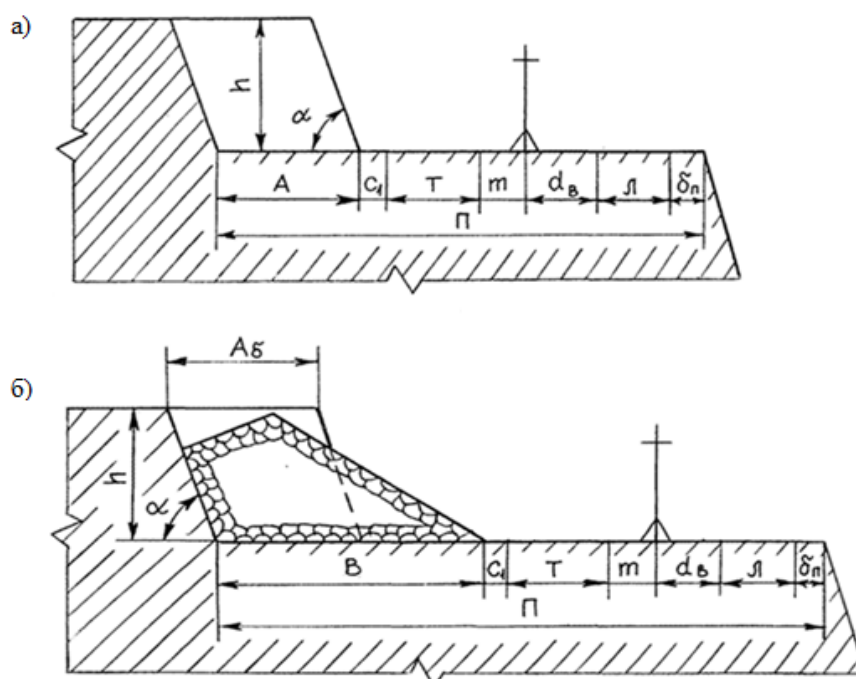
Схема к расчету ширины рабочей площадки в мягких (а) и скальных (б) породах
